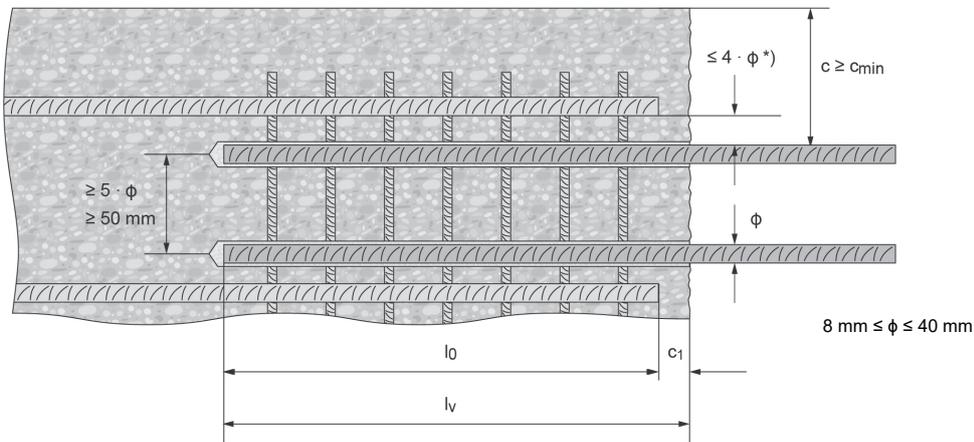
Abstände zwischen existierenden und nachträglich zu installierenden Bewehrungsstäben und Abstand zum (parallelen) Rand.
